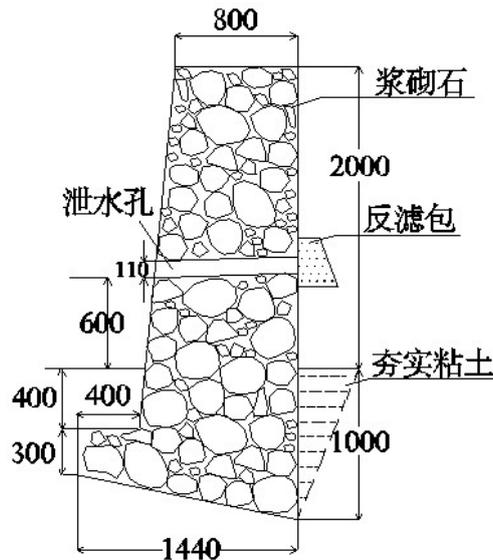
挡渣墙设计断面图 单位：mm
